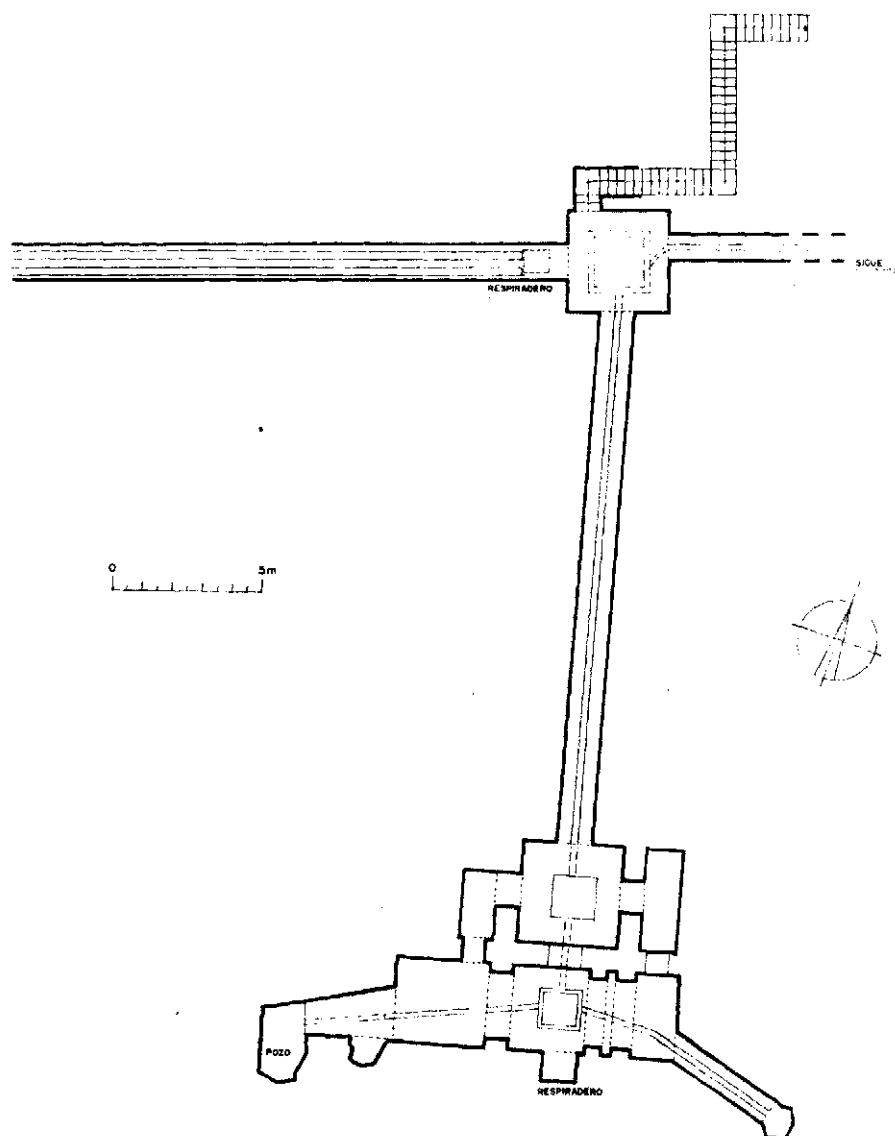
Planta de las galerías de captación. E. 1 : 250
